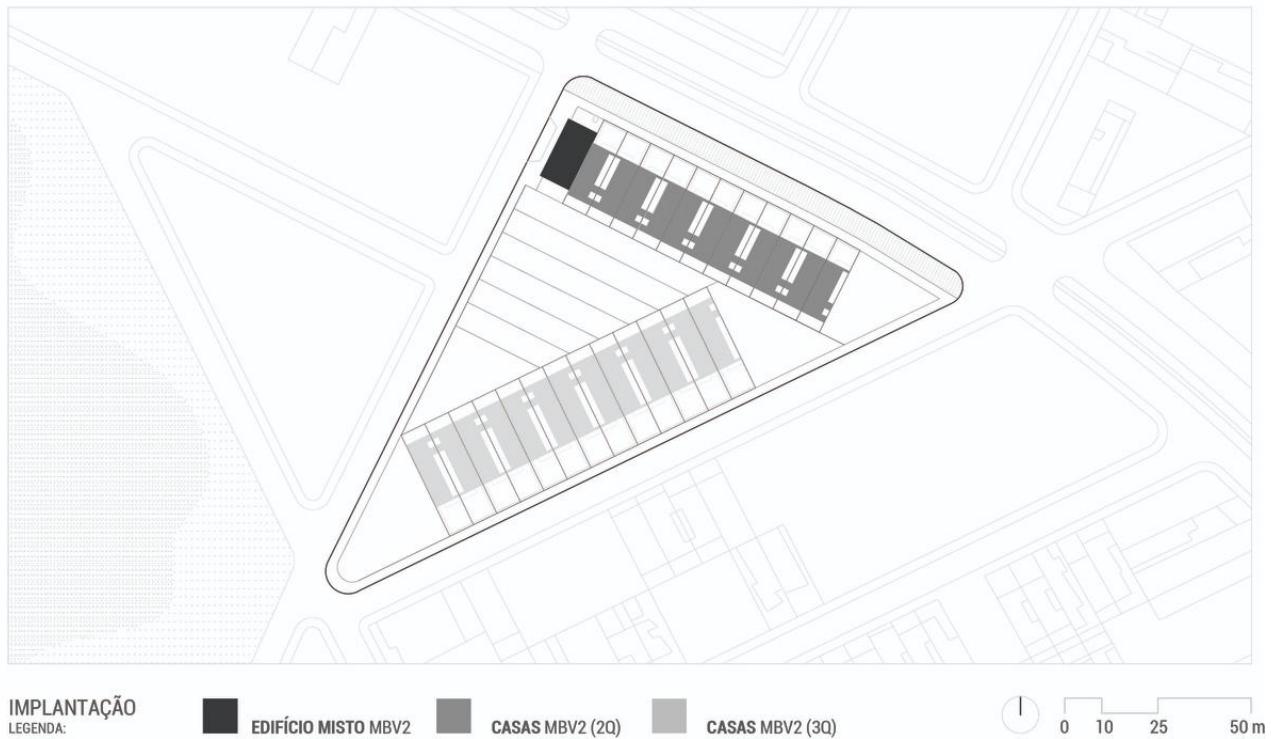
Planta de implantação do conjunto MBV2. Fonte: Elaboração própria (2020).
